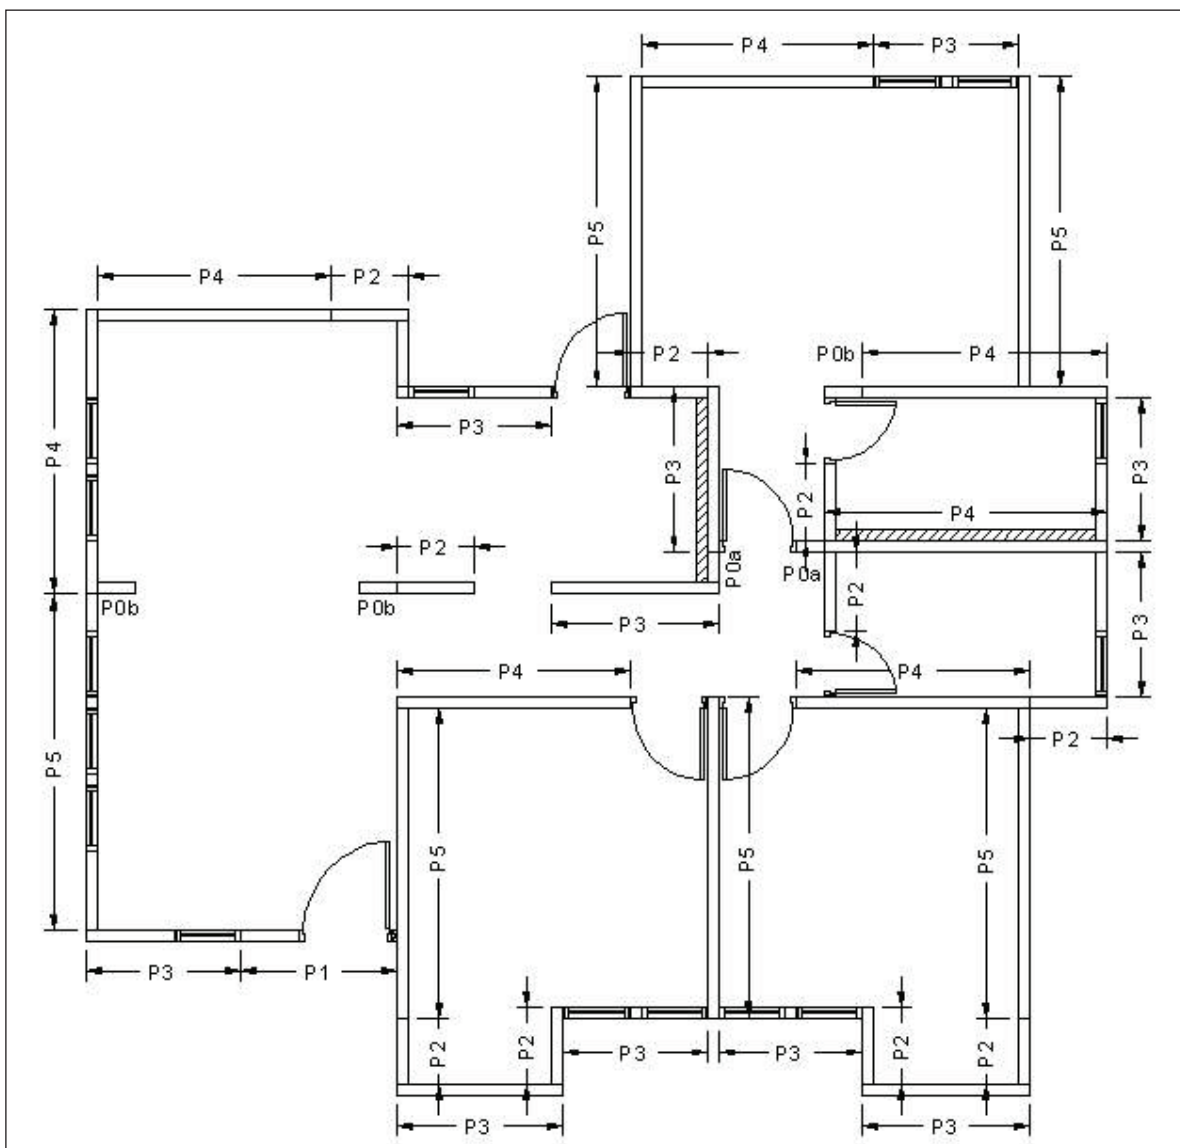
Planta rediseñada del Modelo 1, con la distribución de paneles realizados por los autores.
